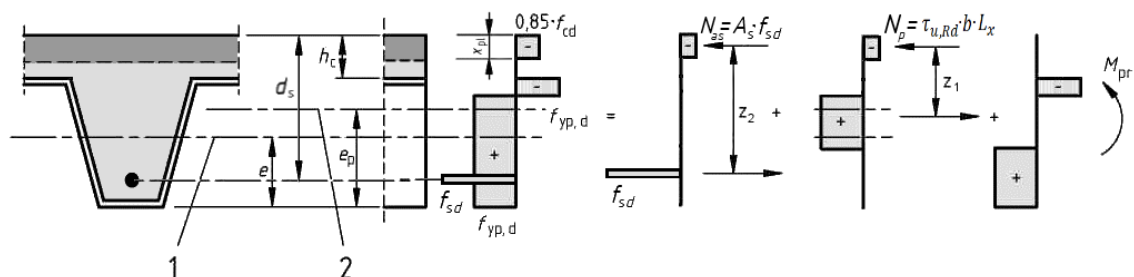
Напряжения при положительном моменте и нейтральной оси в пределах настила с учетом растянутой арматуры
